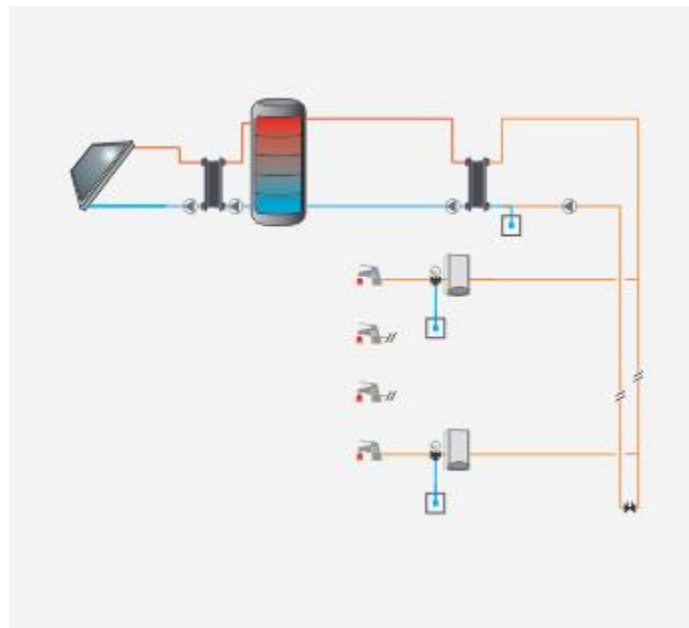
Esquema de la instalación con apoyo distribuido [CHEQ4]
